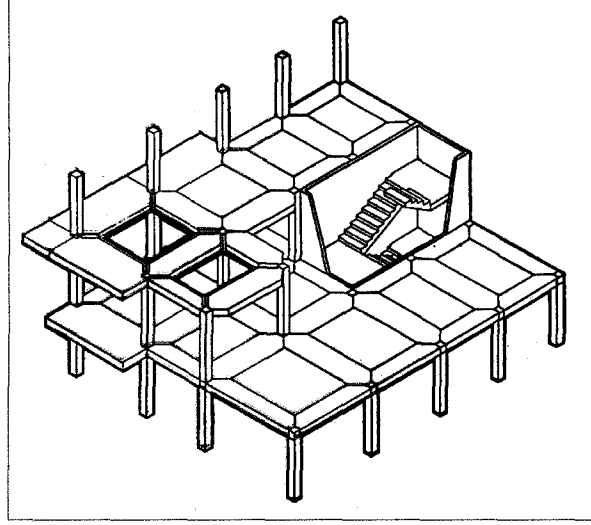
Büyük Açıklıklı Betonarme Prefabrike Yapım Sistemleri
